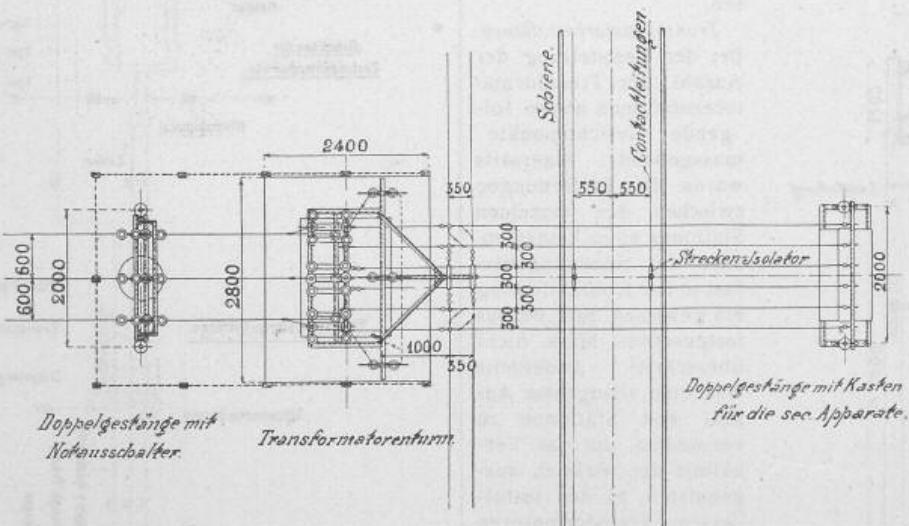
Grundriss zu Fig. 10. — 1:100.
